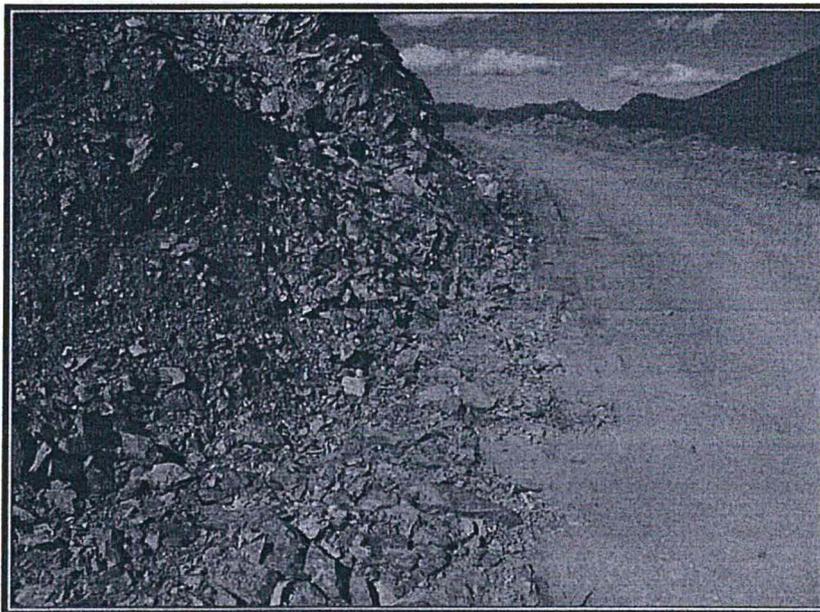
Hallazgo N° 1 Vías de acceso al campamento con falta de infraestructura hidráulica.
